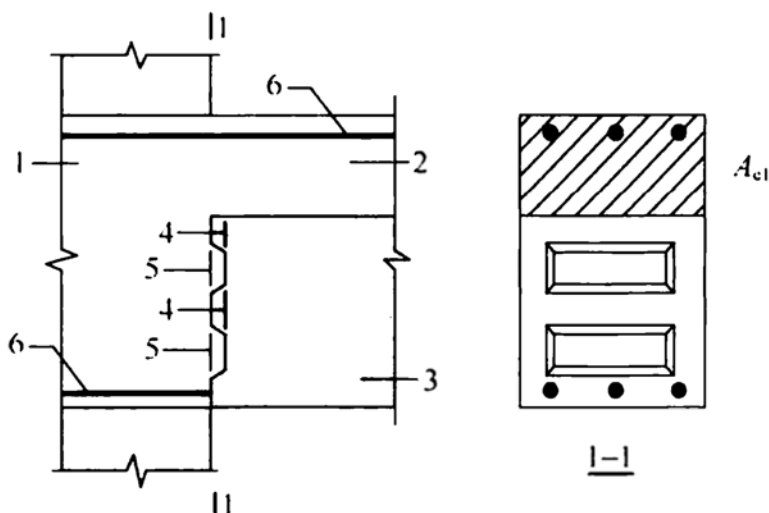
叠合梁端部受剪承载力计算参数示意
